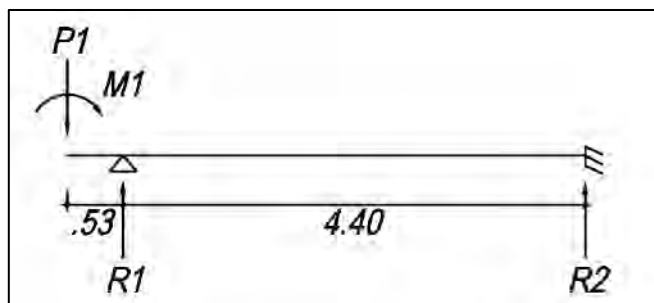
Modelo estructural en metros de las zapatas conectadas Z-06 y Z-07
